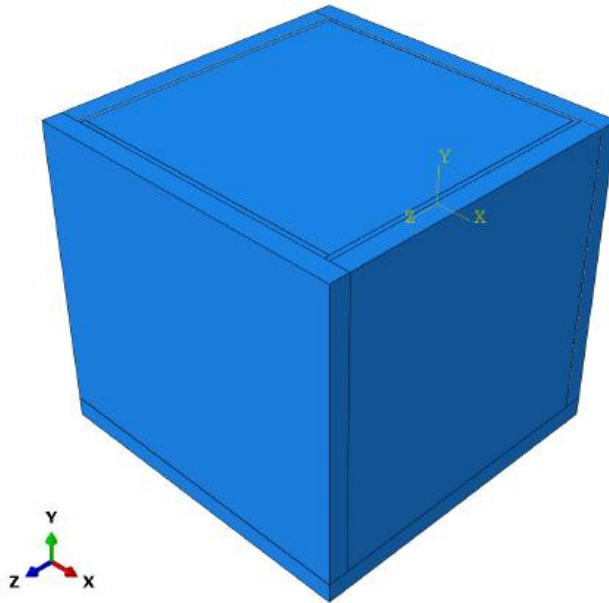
Cubo de hormigón con encofrado de madera y aislación de poliestireno
